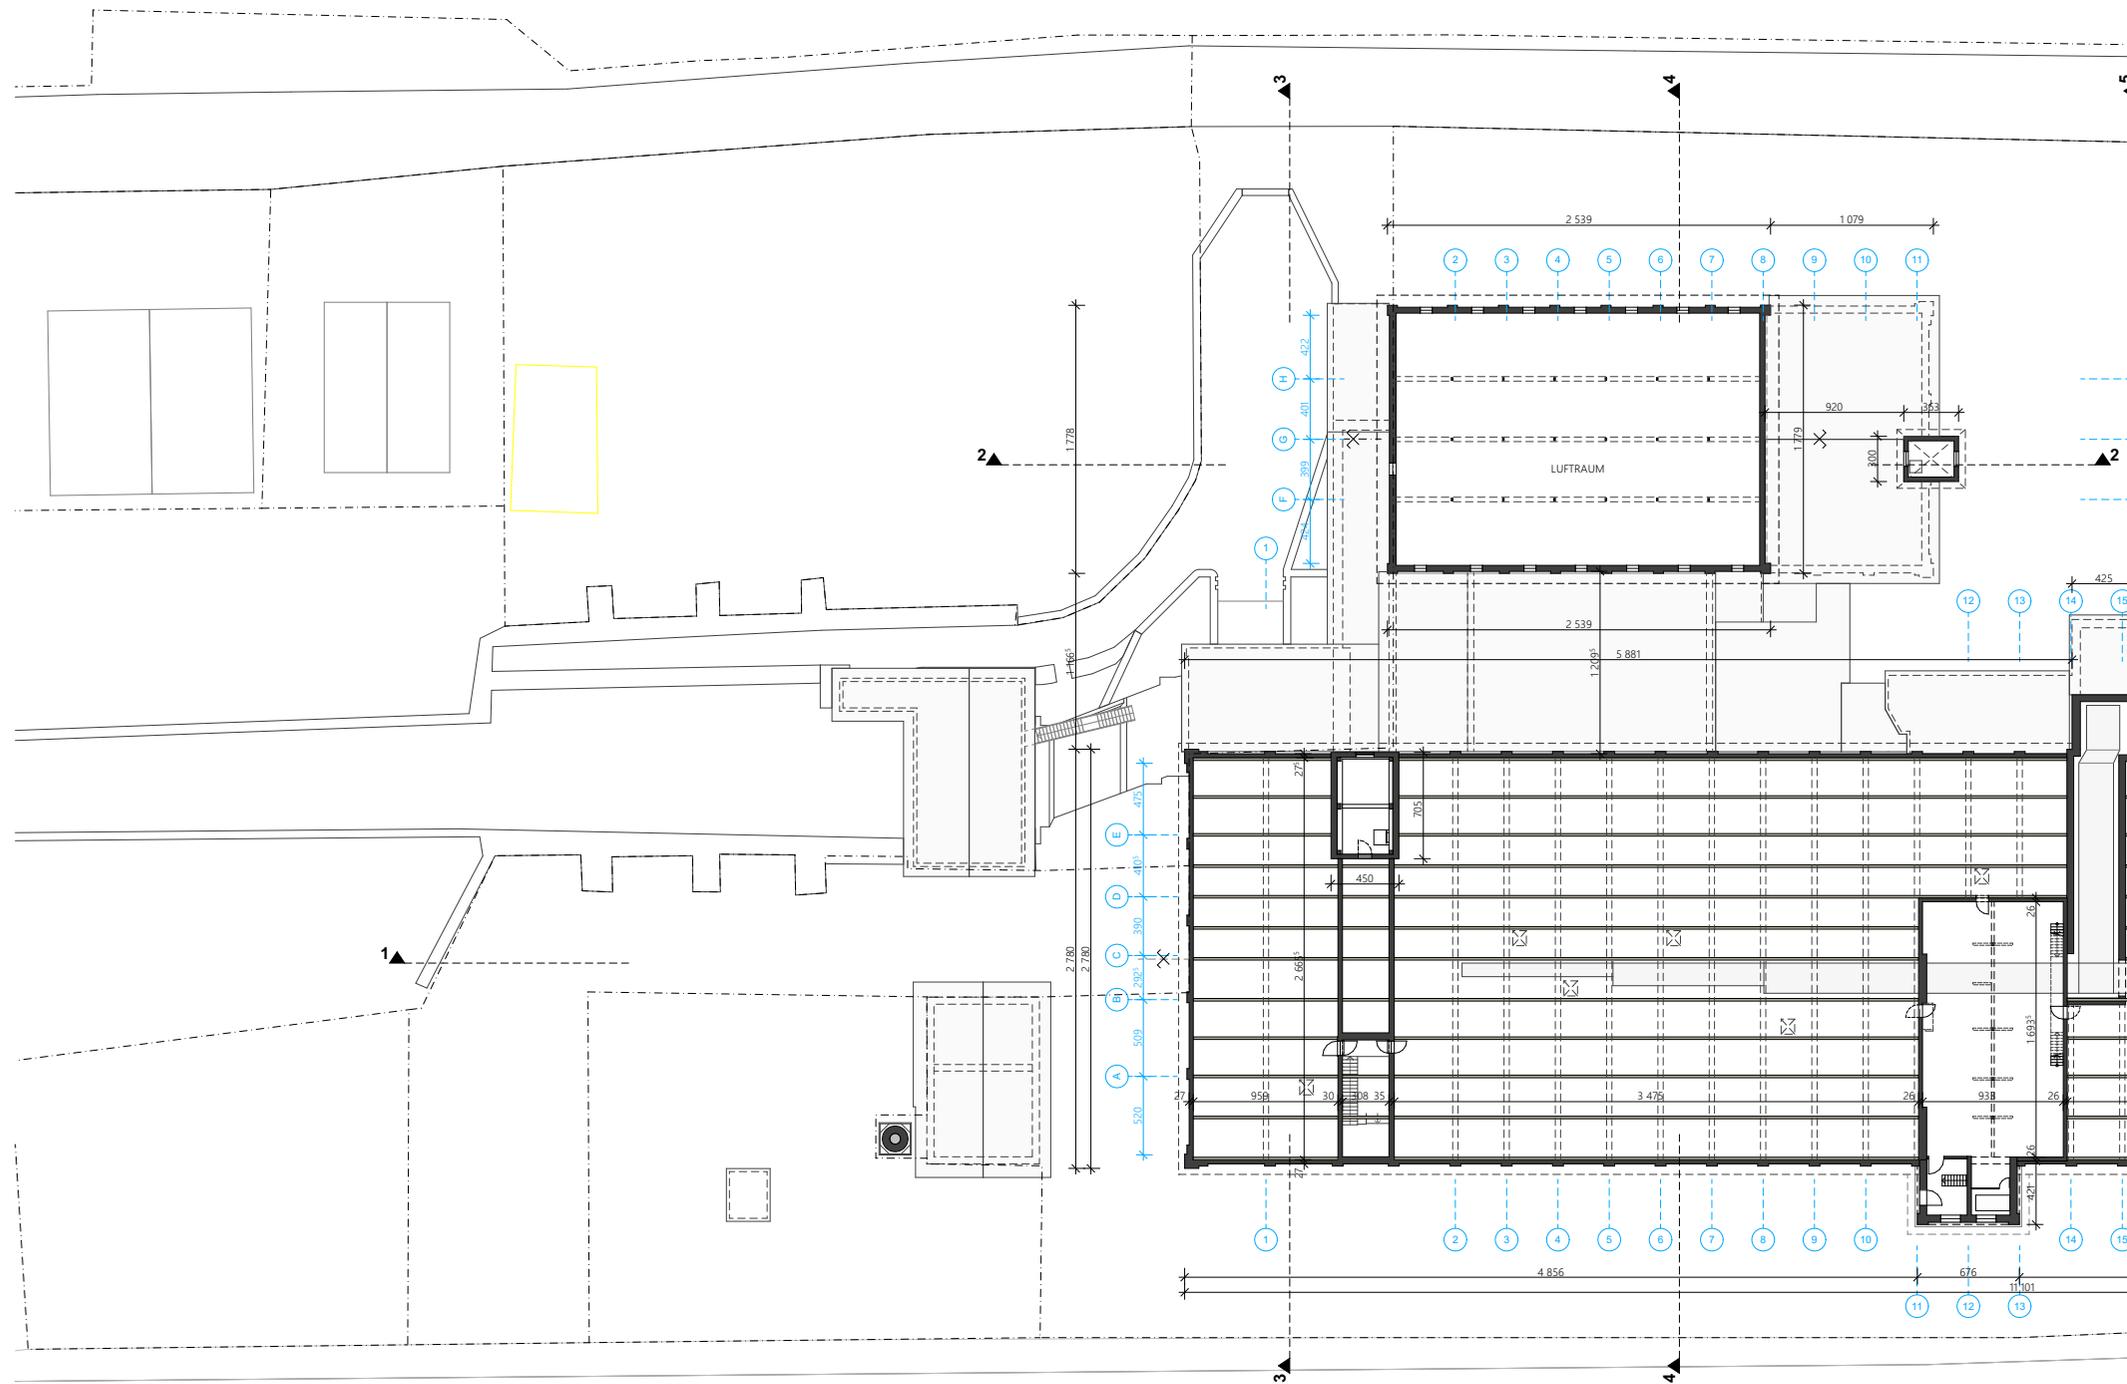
Grundriss Obergeschoß, M 1:500
